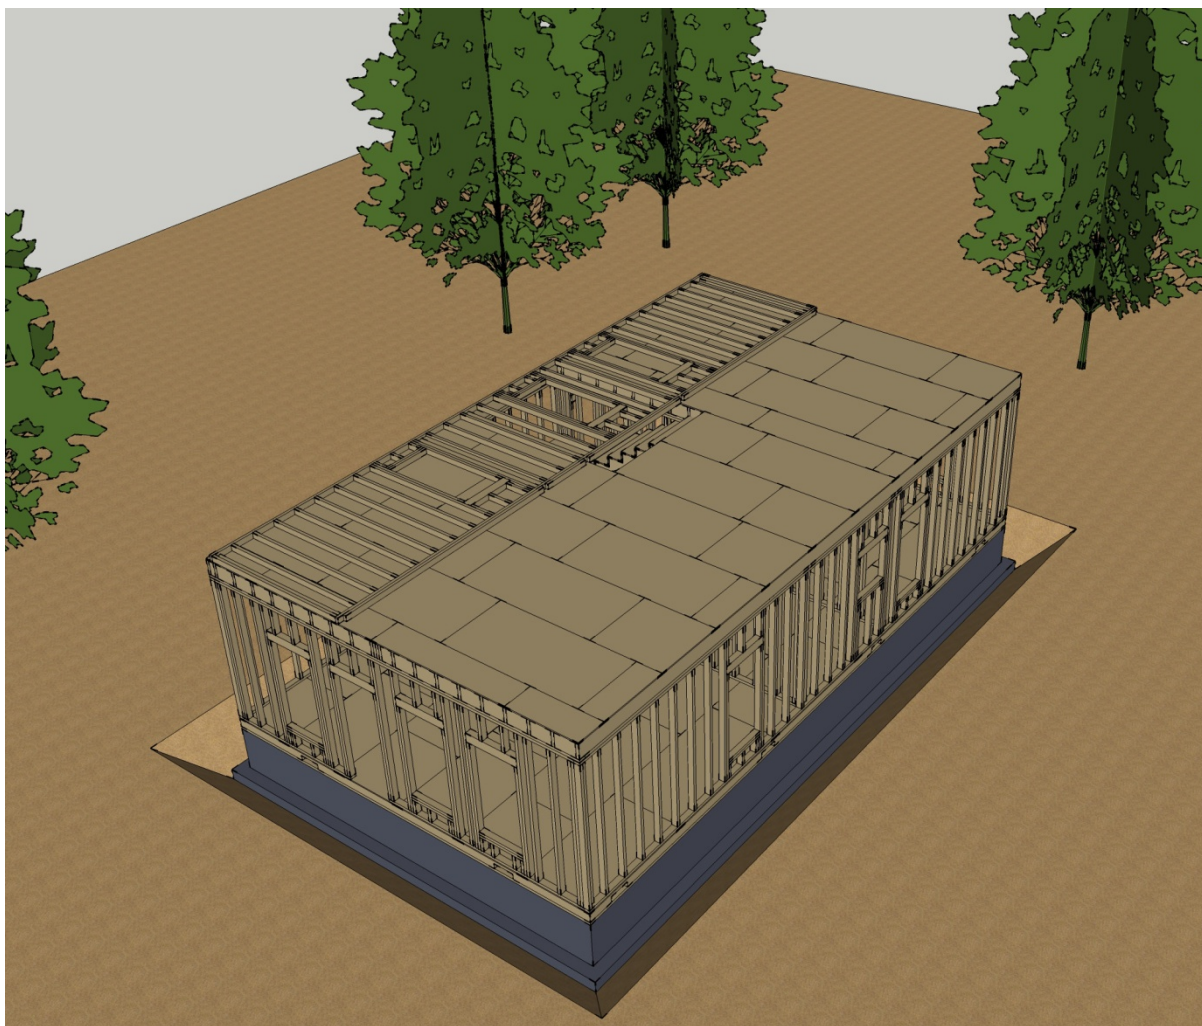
Montagem de parede exterior sobre o pavimento.
